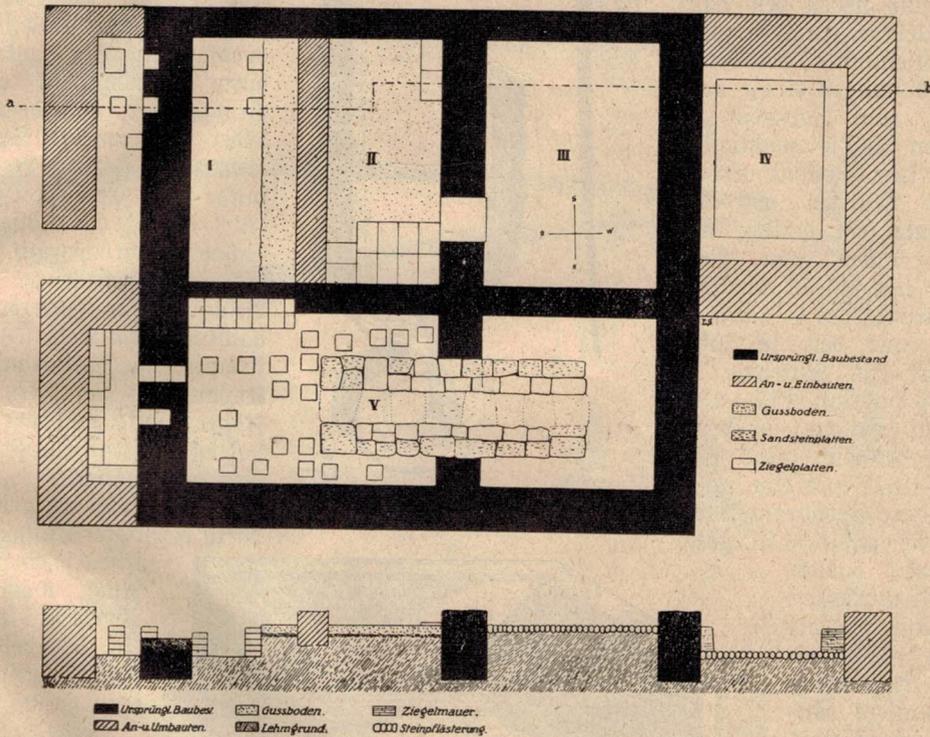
Ruine C. Grundriß 1 : 100. — Schnitt a—b 1 : 100.
